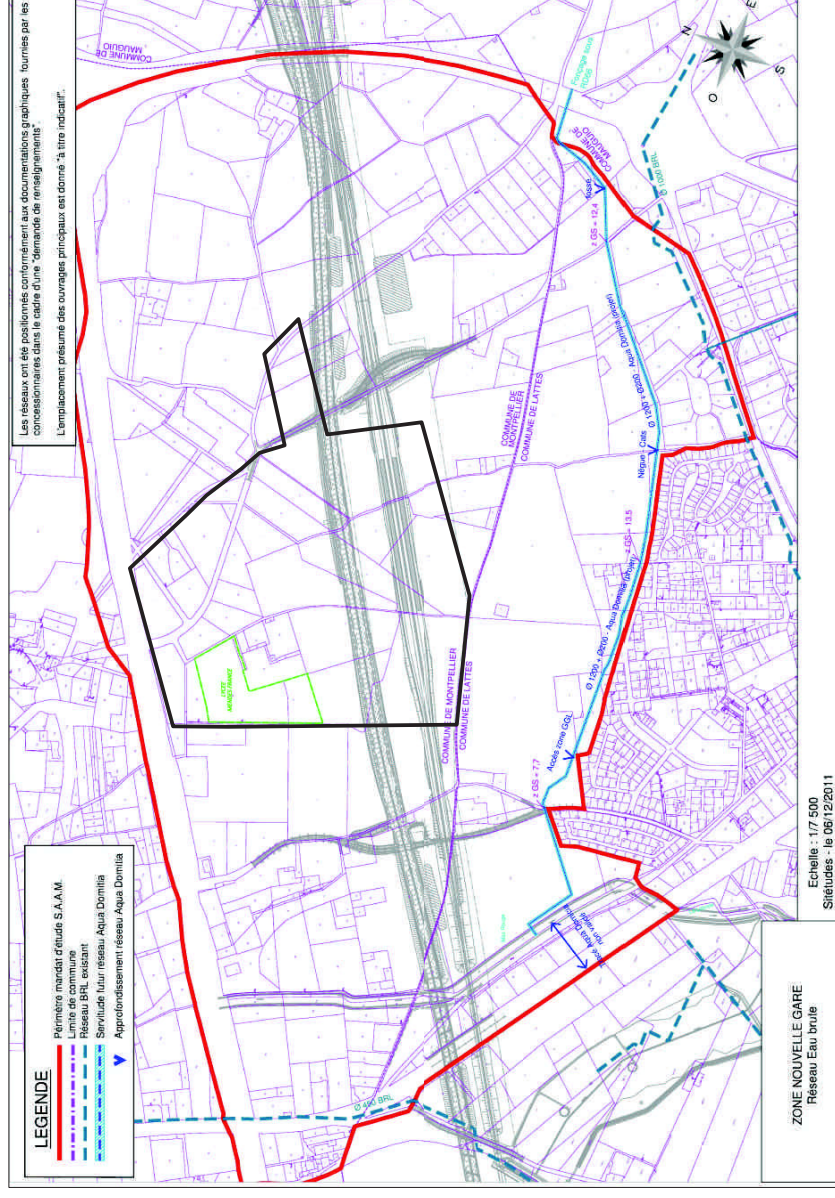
Plan des réseaux d'irrigation sur la zone d'étude
